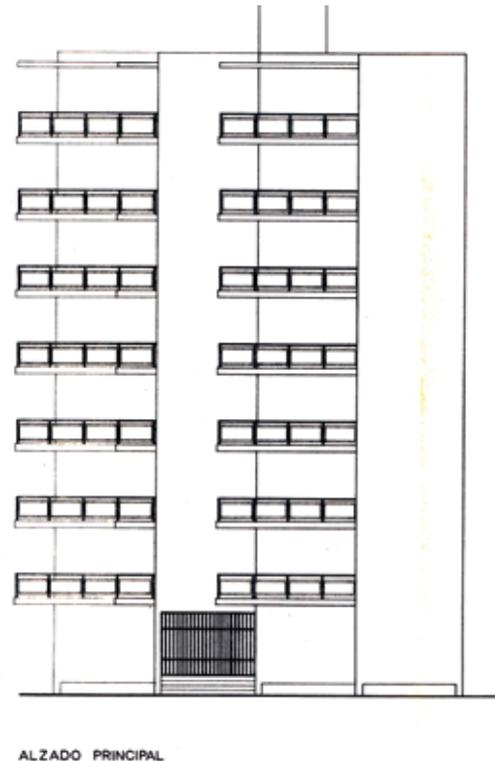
Miguel Fisac y José Ramón Azpiazu. 1963-65. Proyectos de 32+48 viviendas en Las Delicias, Águilas. Alzado (Fuentes: Fundación Miguel Fisac y Archivo Municipal de Águilas).
